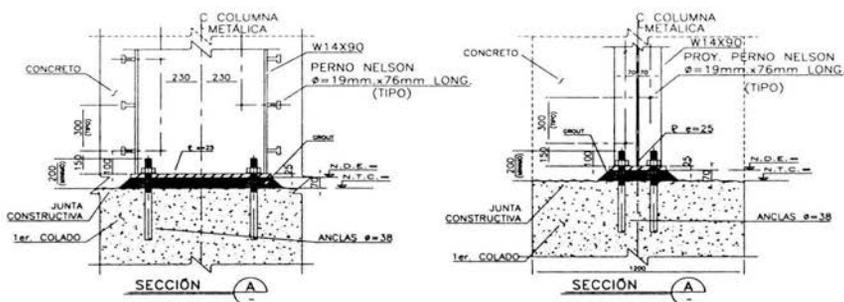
Detalle de pernos en columnas ahogadas en concreto.
